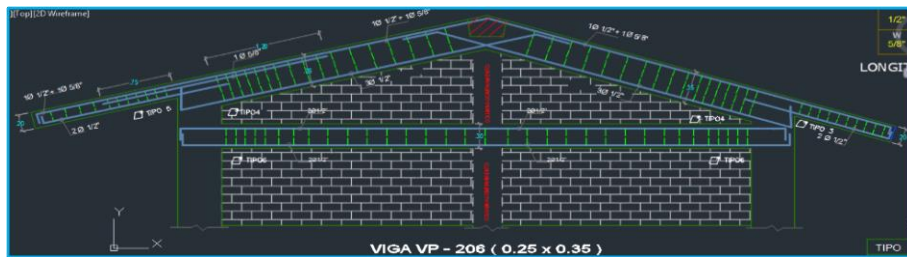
Detalle de las dimensiones de la viga VP-206 y el acero de refuerzo
